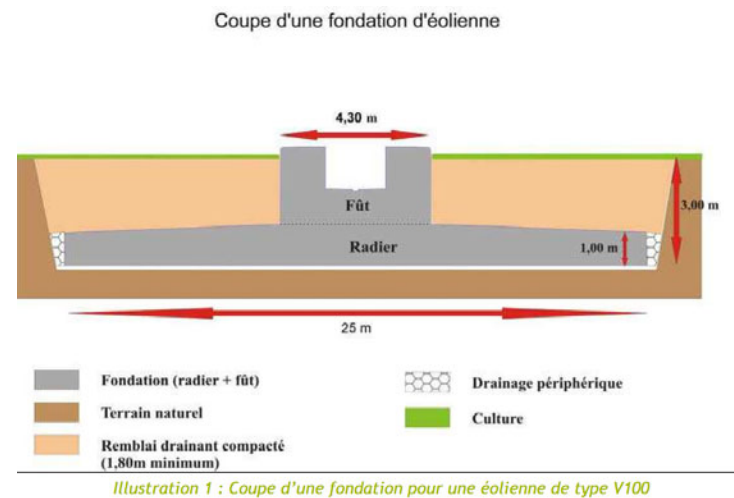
Coupe d'une fondation pour une éolienne de type V100
